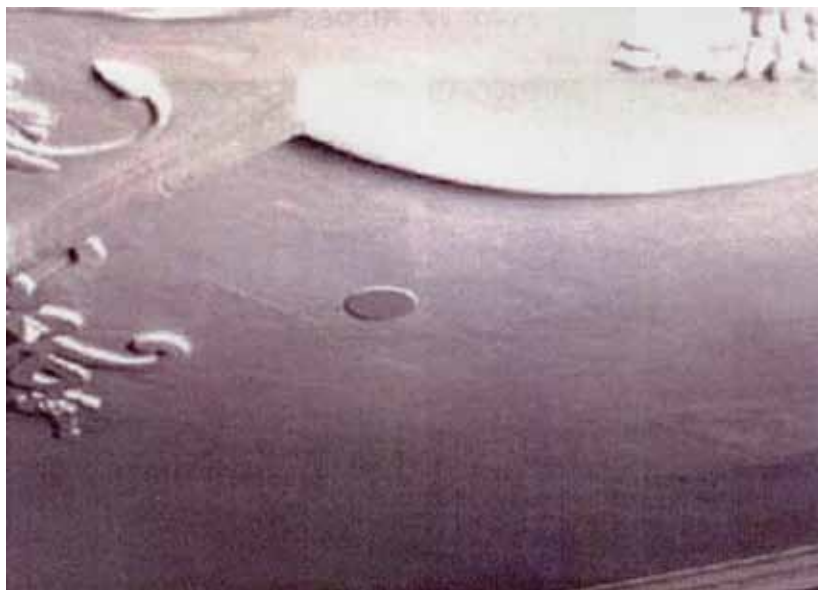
Stěnový sprinkler málo patrný ve štukové výzdobě.
